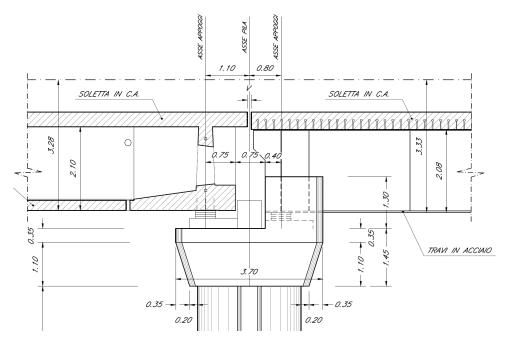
Pila, prospetto longitudinale – Impalcato CAP e impalcato a struttura mista [m]
